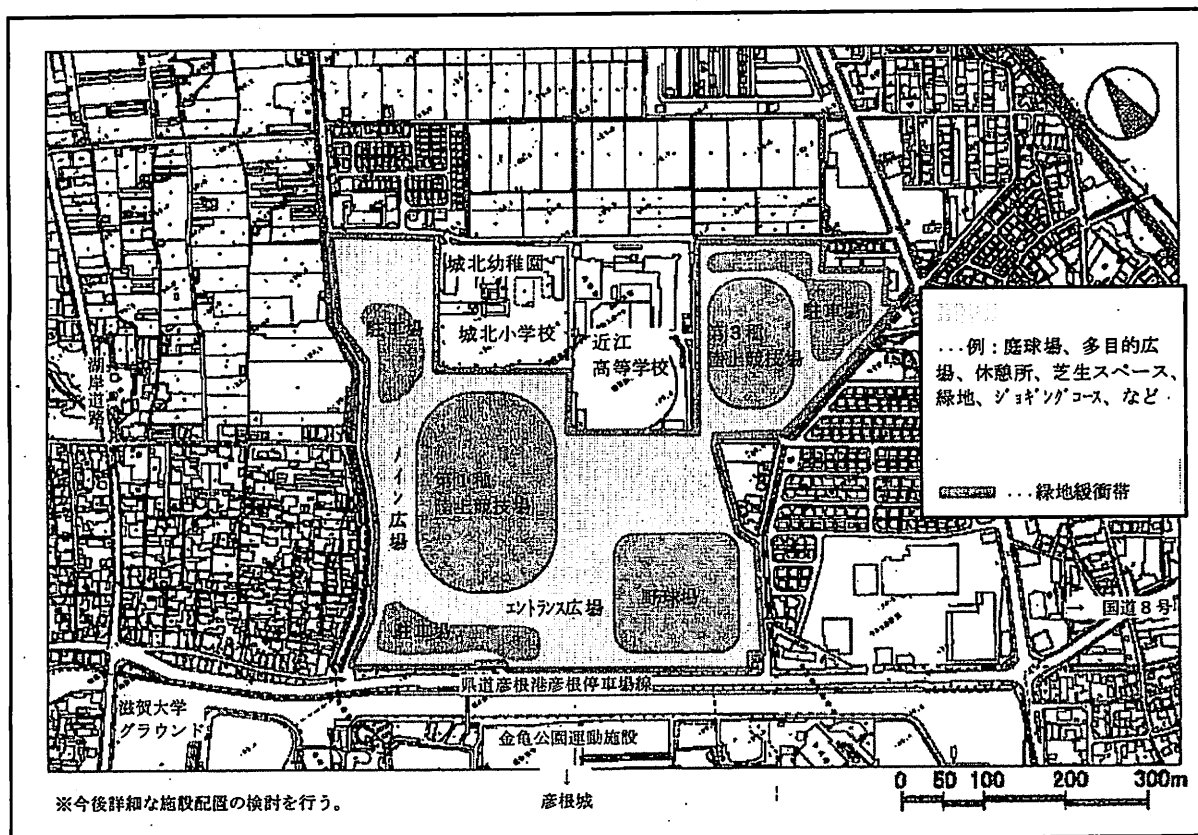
基本構想時の施設配置図（ゾーニング図）案
